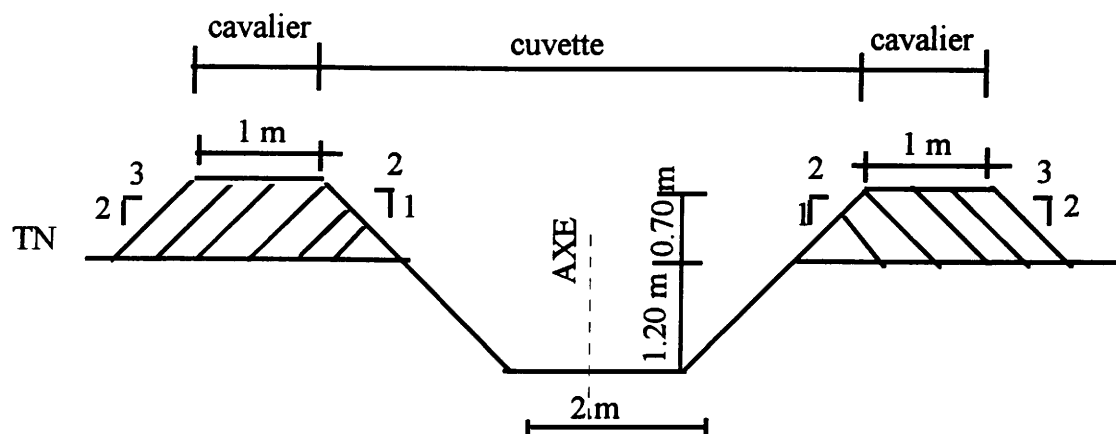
profil en travers type de l'arroiseur bilatéral
